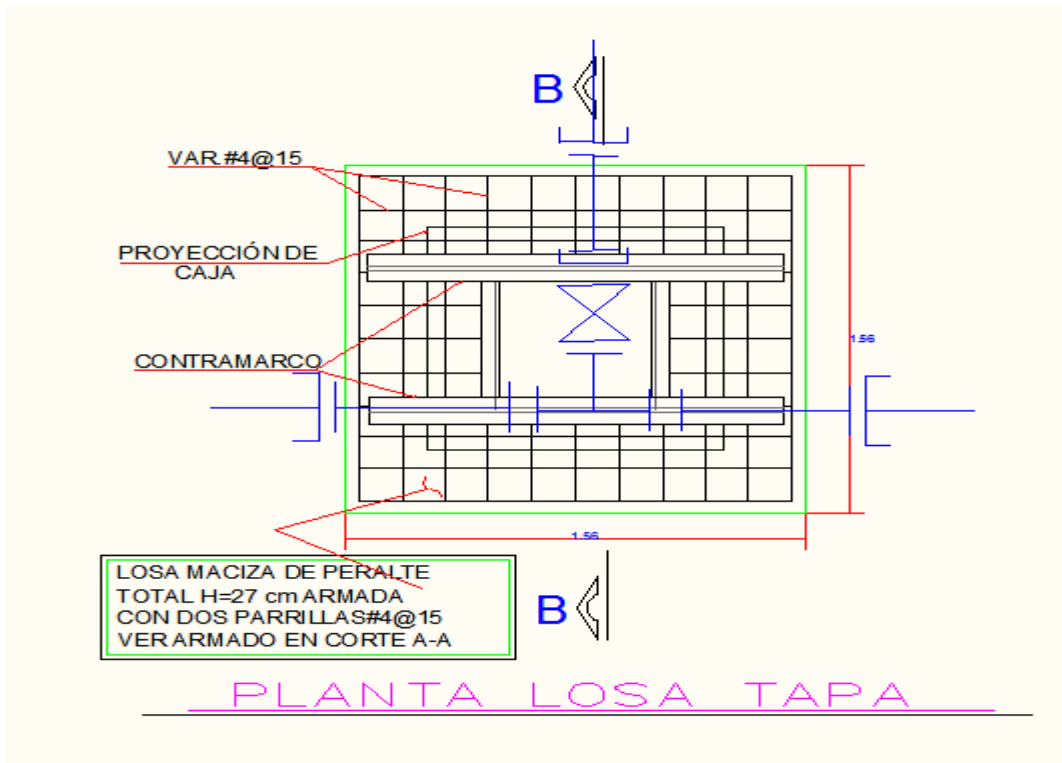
PLANTA DE LA LOSA TAPA DE LA CAJA TIPO 1-1-A
